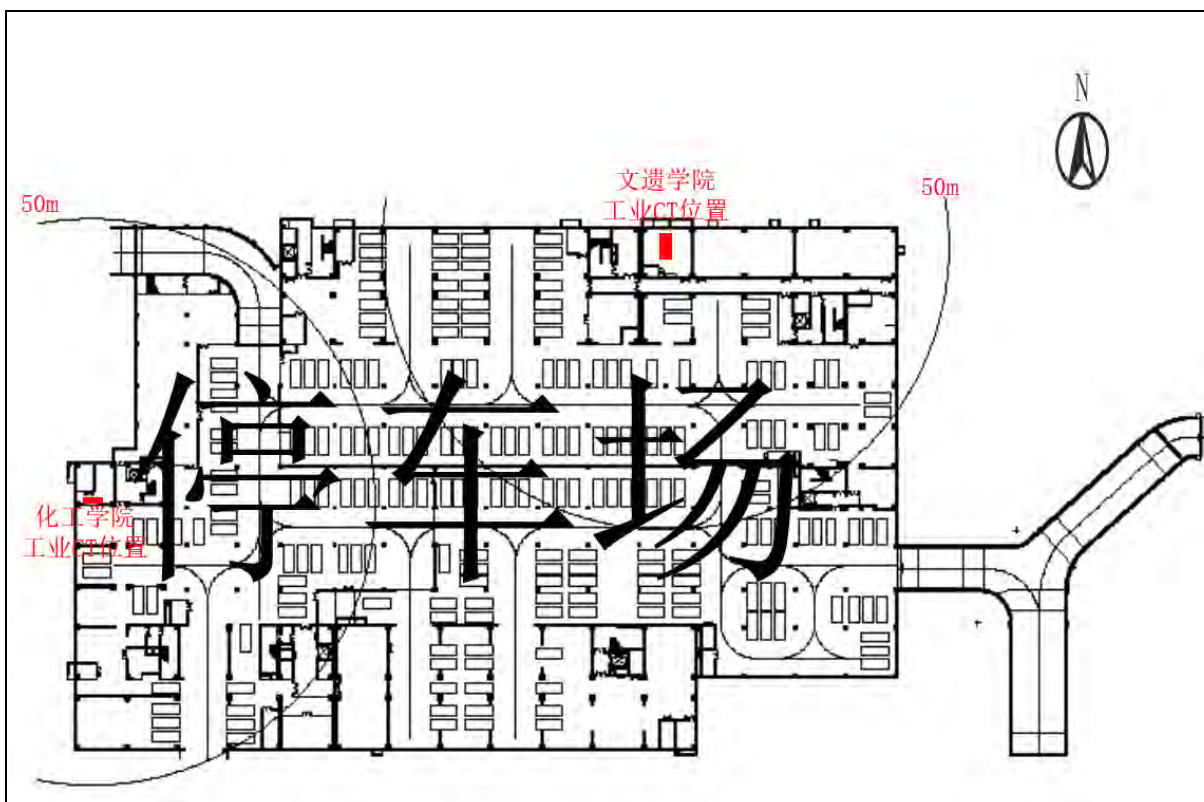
文遗学院负 1 楼和化工学院负 1 楼平面布置图
